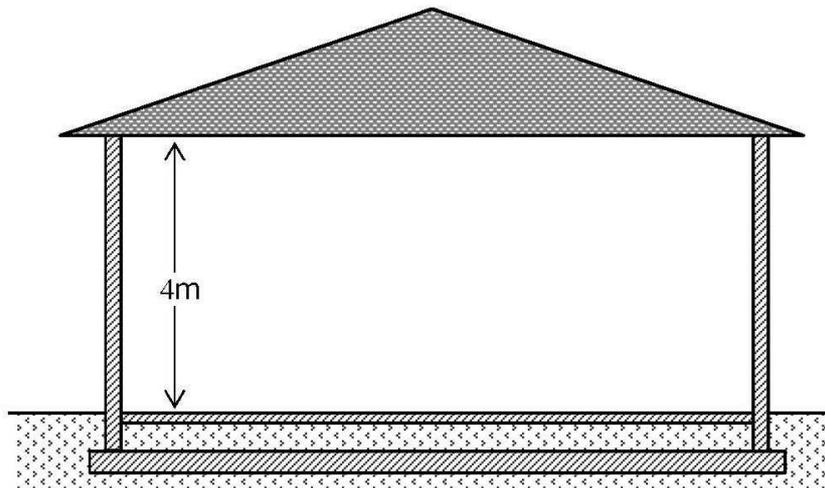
Exemple d'un bâtiment de type 4 : bâtiment d'activité agricole ou entrepôts
